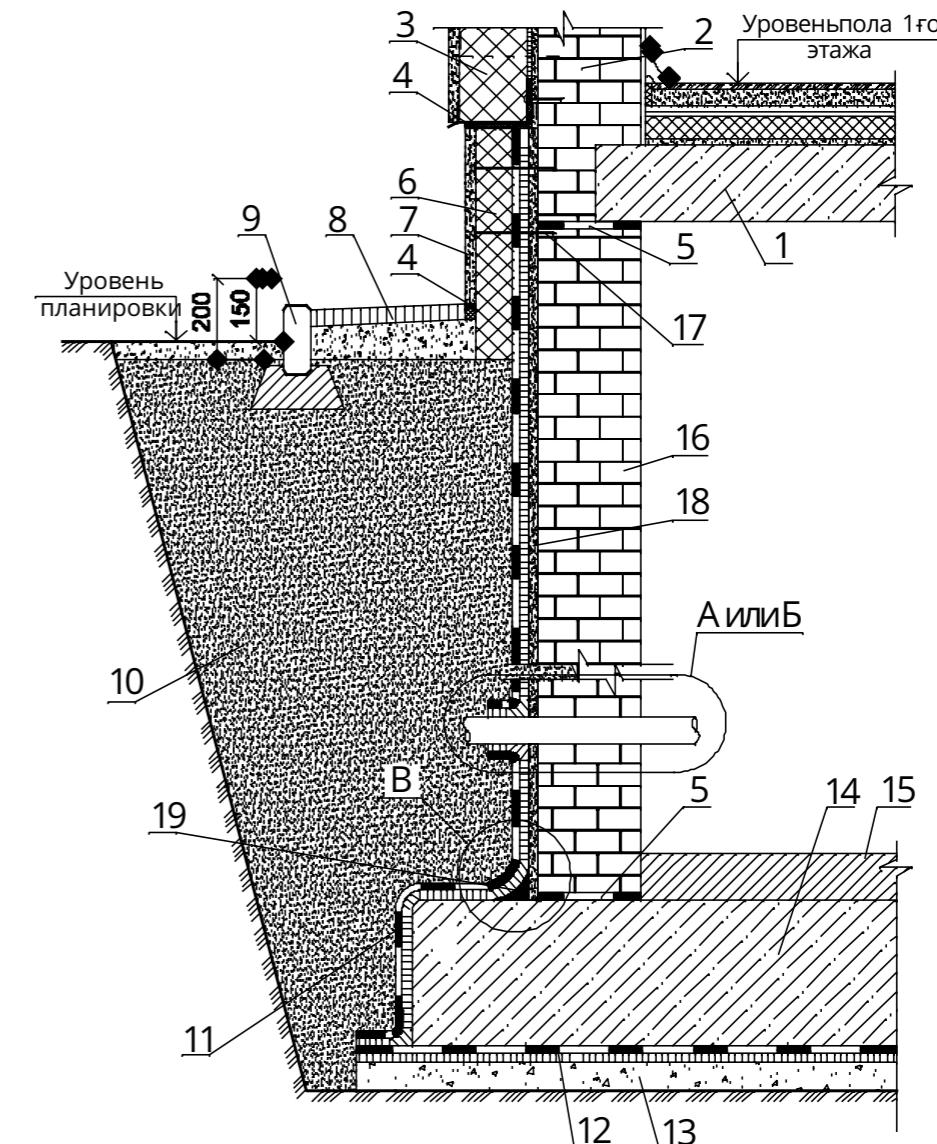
Узел 1. Гидроизоляция стены подвала из мелкоштучных изделий и фундаментной плиты здания
